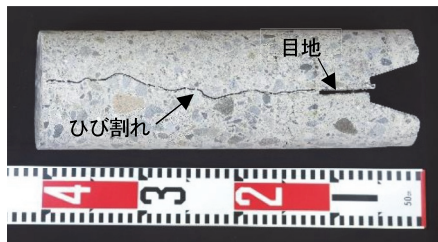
側壁目地部コアのひび割れ (Case5)
